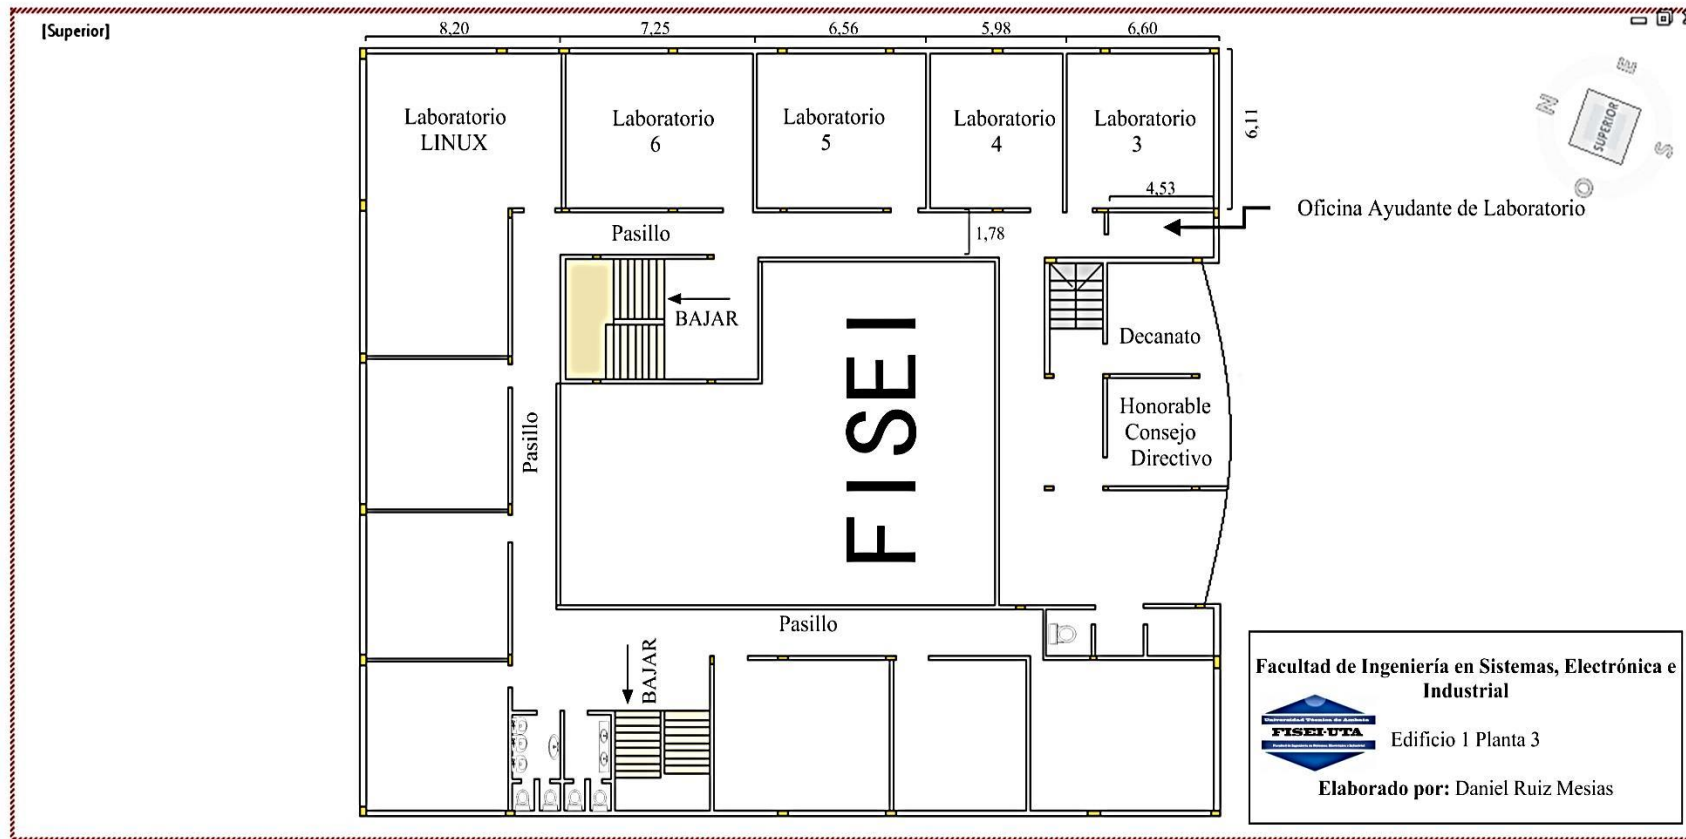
Planos de la tercera planta del edificio 1 de la FISEI –UTA.
